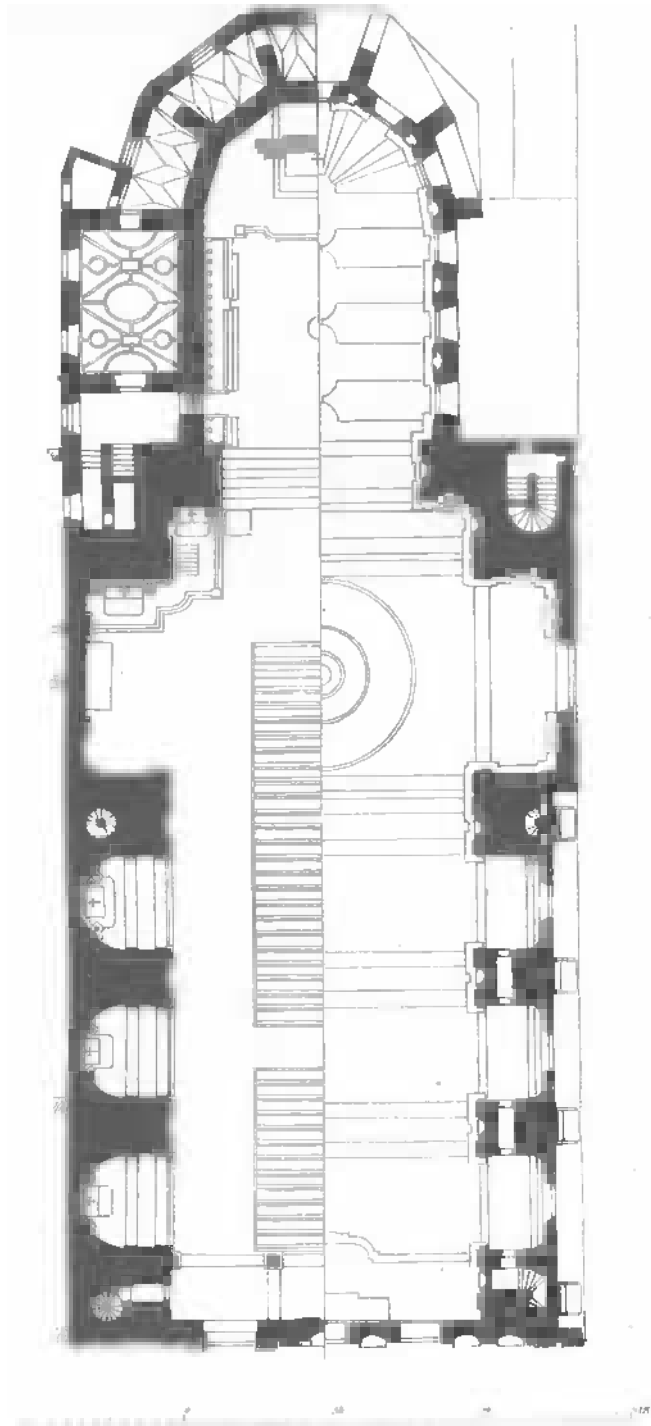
St. Michaelskirche, München. Grundriss (n. Ortwein).
